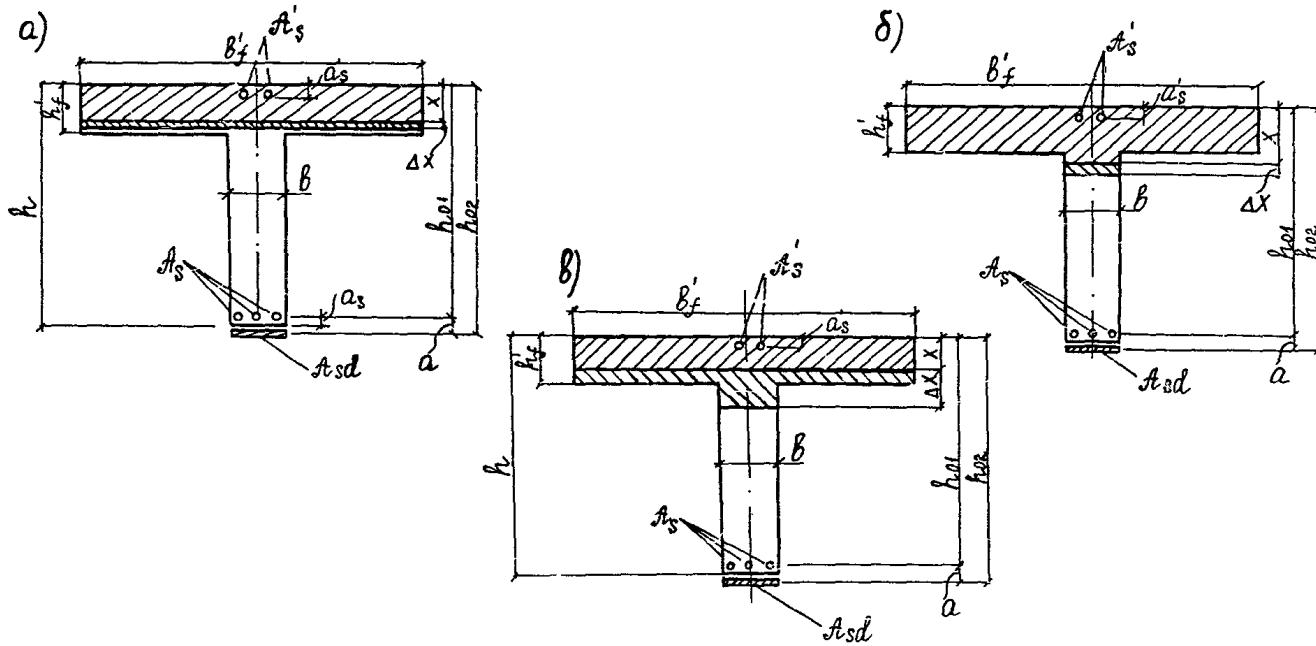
Поперечное сечение тавровой железобетонной балки:
